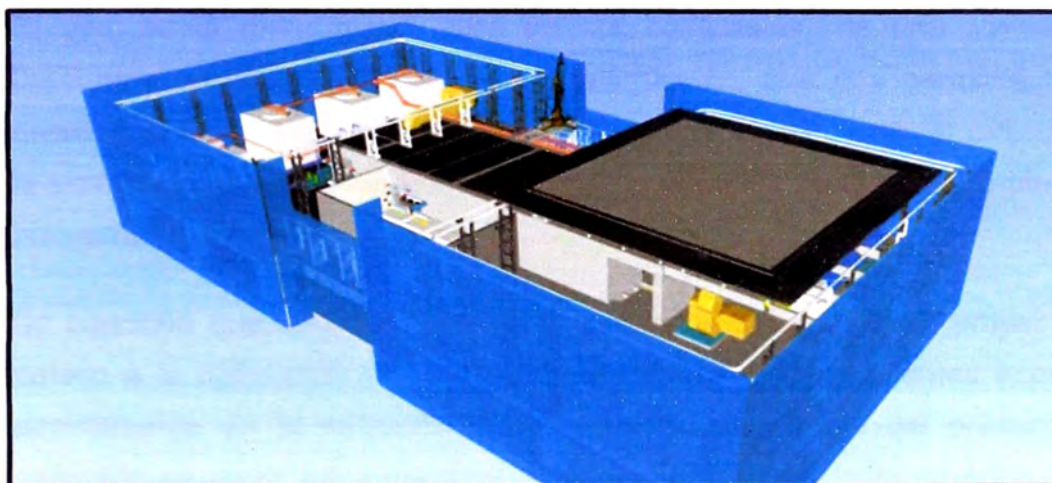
44: 4D de la Coronación del Edificio, Desmontaje del miniderrick, fin de colocación de muro cortina
